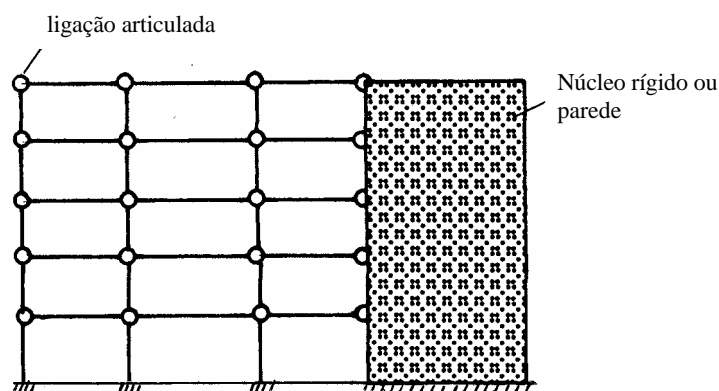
Princípios de contraventamento para estrutura de esqueleto com ligações viga-pilar articuladas
